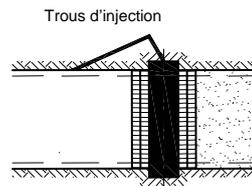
Conception Générale d'un Serrement en Béton avec Fermeture au Bitume
